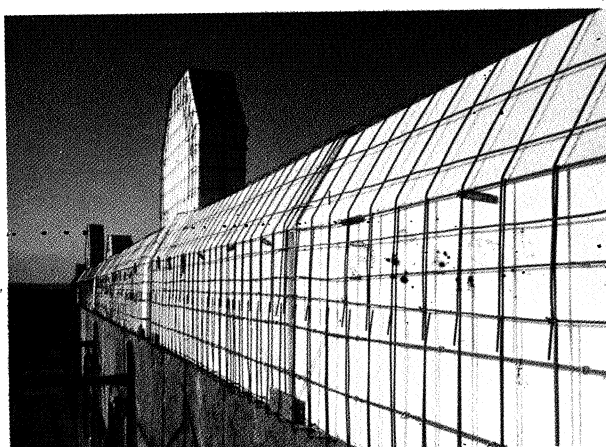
Mallas de solape colocados sobre remates de cubierta de paneles D-P.I.
